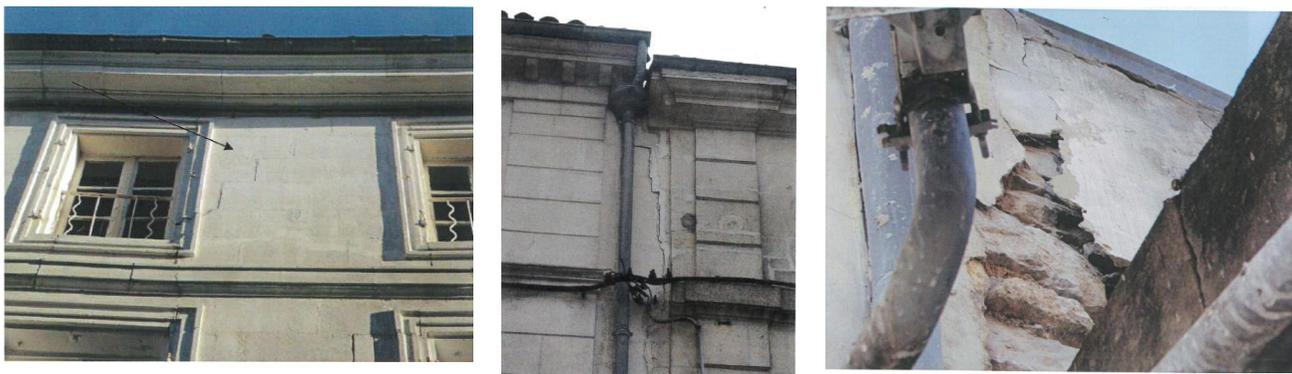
Photos des façades des immeubles (source : PV de constat Huissier de Justice SELARL MORIN RENARD, 2017 et 2020)
